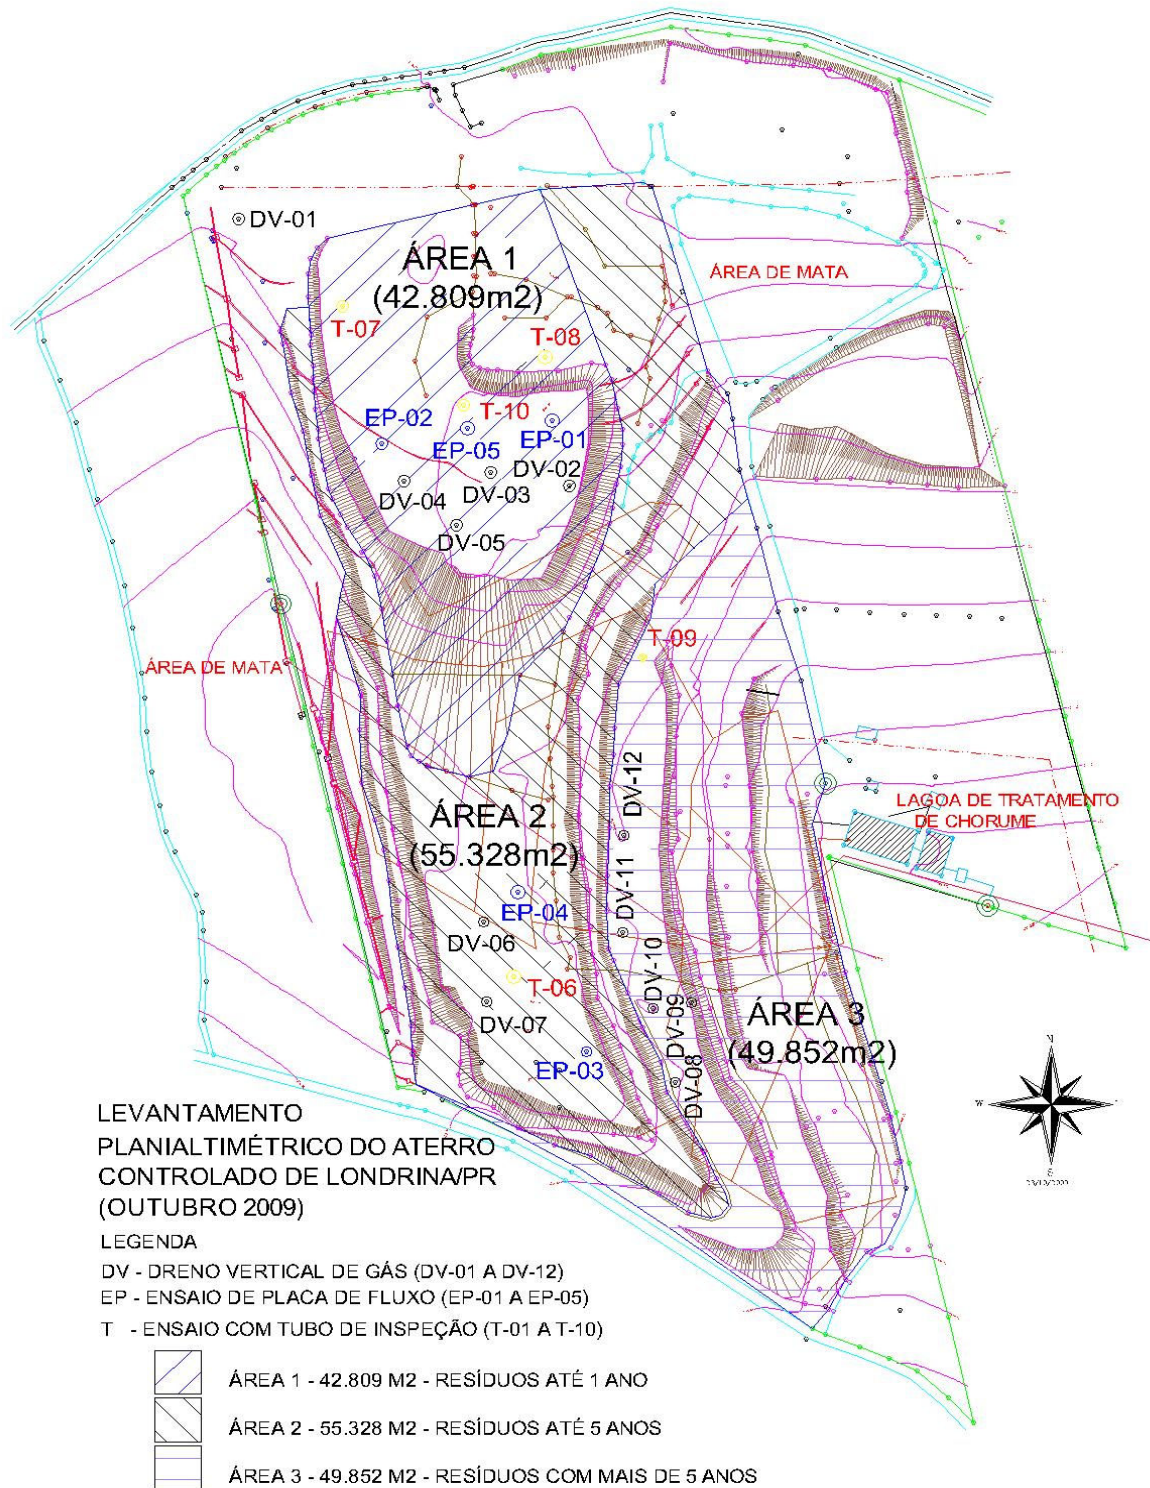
Levantamento planialtimétrico simplificado do aterro de Londrina e localização dos pontos de ensaios na primeira campanha de medidas (outubro/2009)
